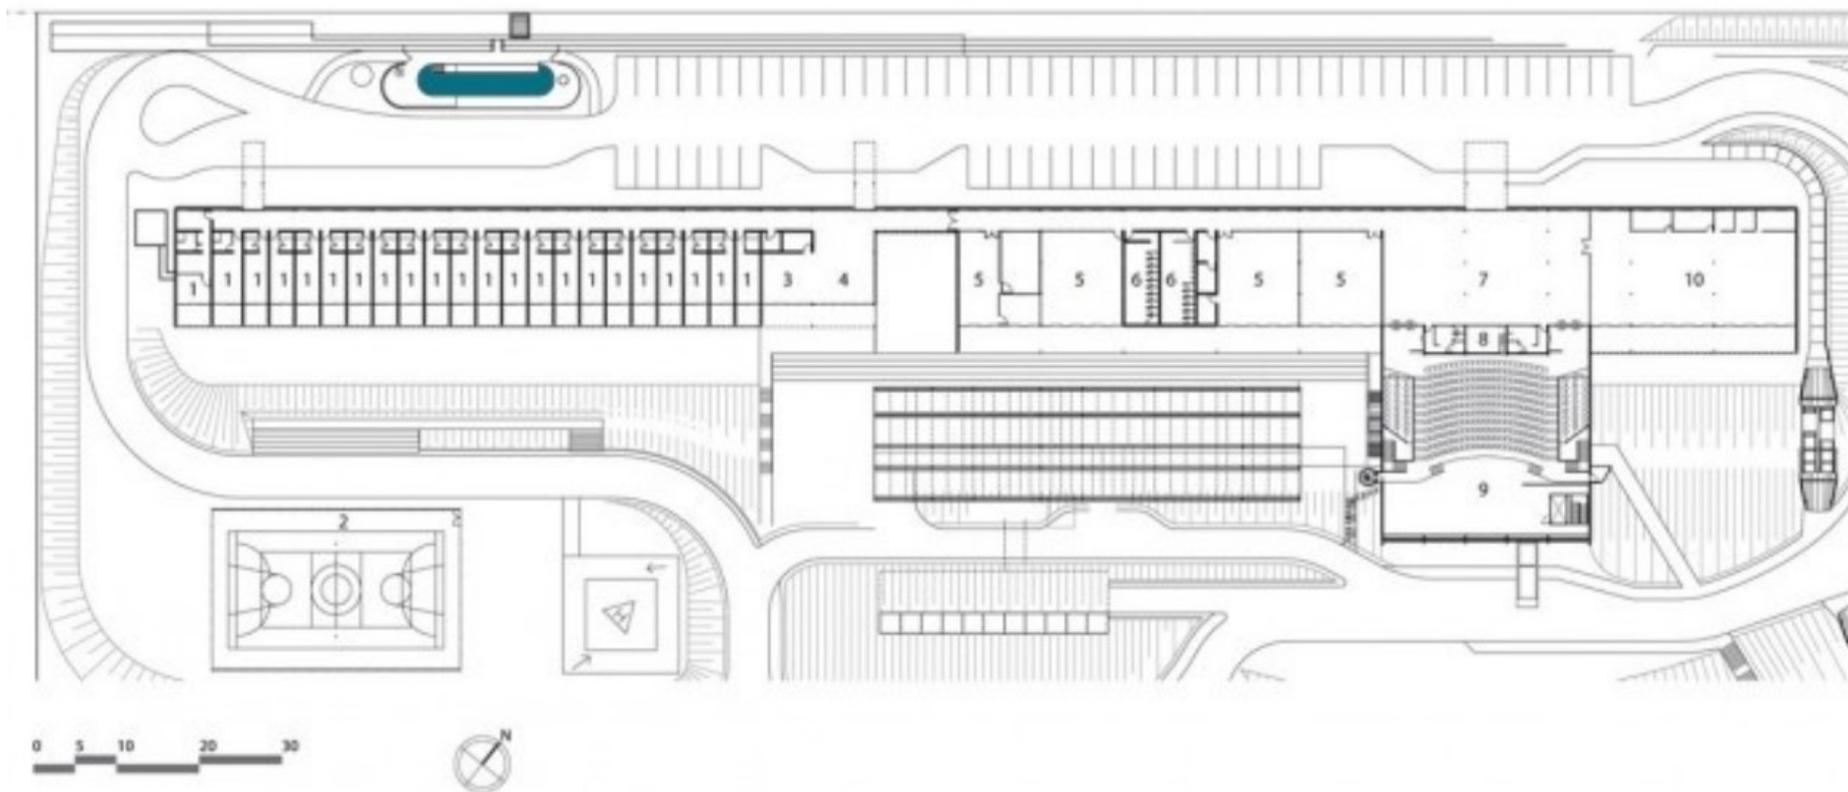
Sarah Lago Norte Brasília – Prédio de residência médica e centro de estudos – Planta Pavimento Térreo -
